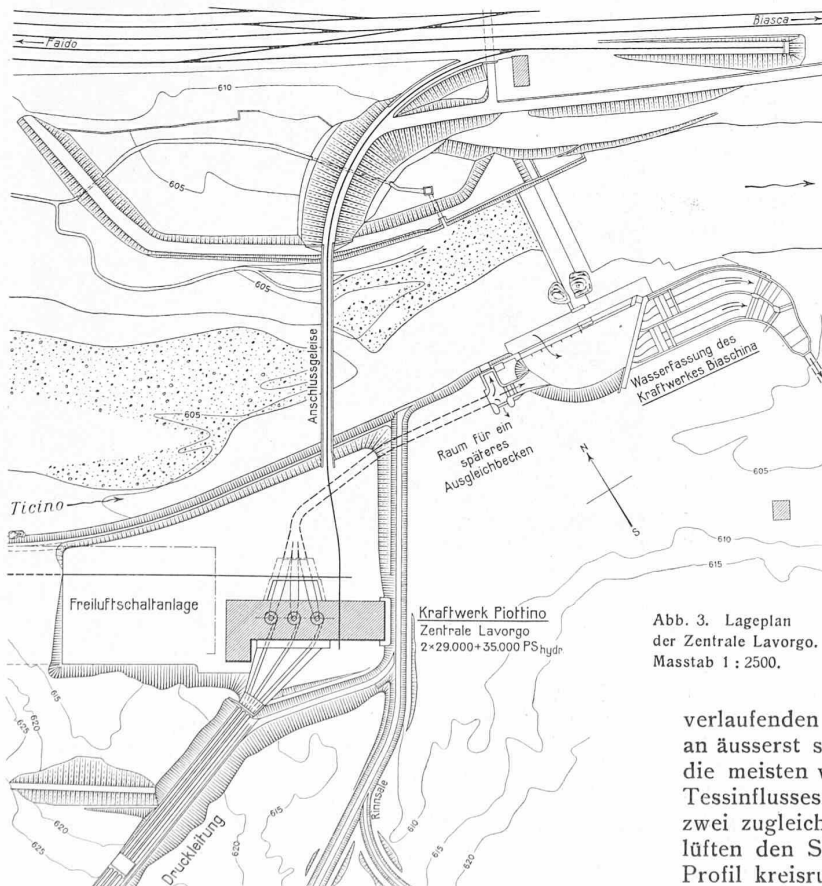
Lageplan der Zentrale Lavorgo. Masstab 1 : 2500.
